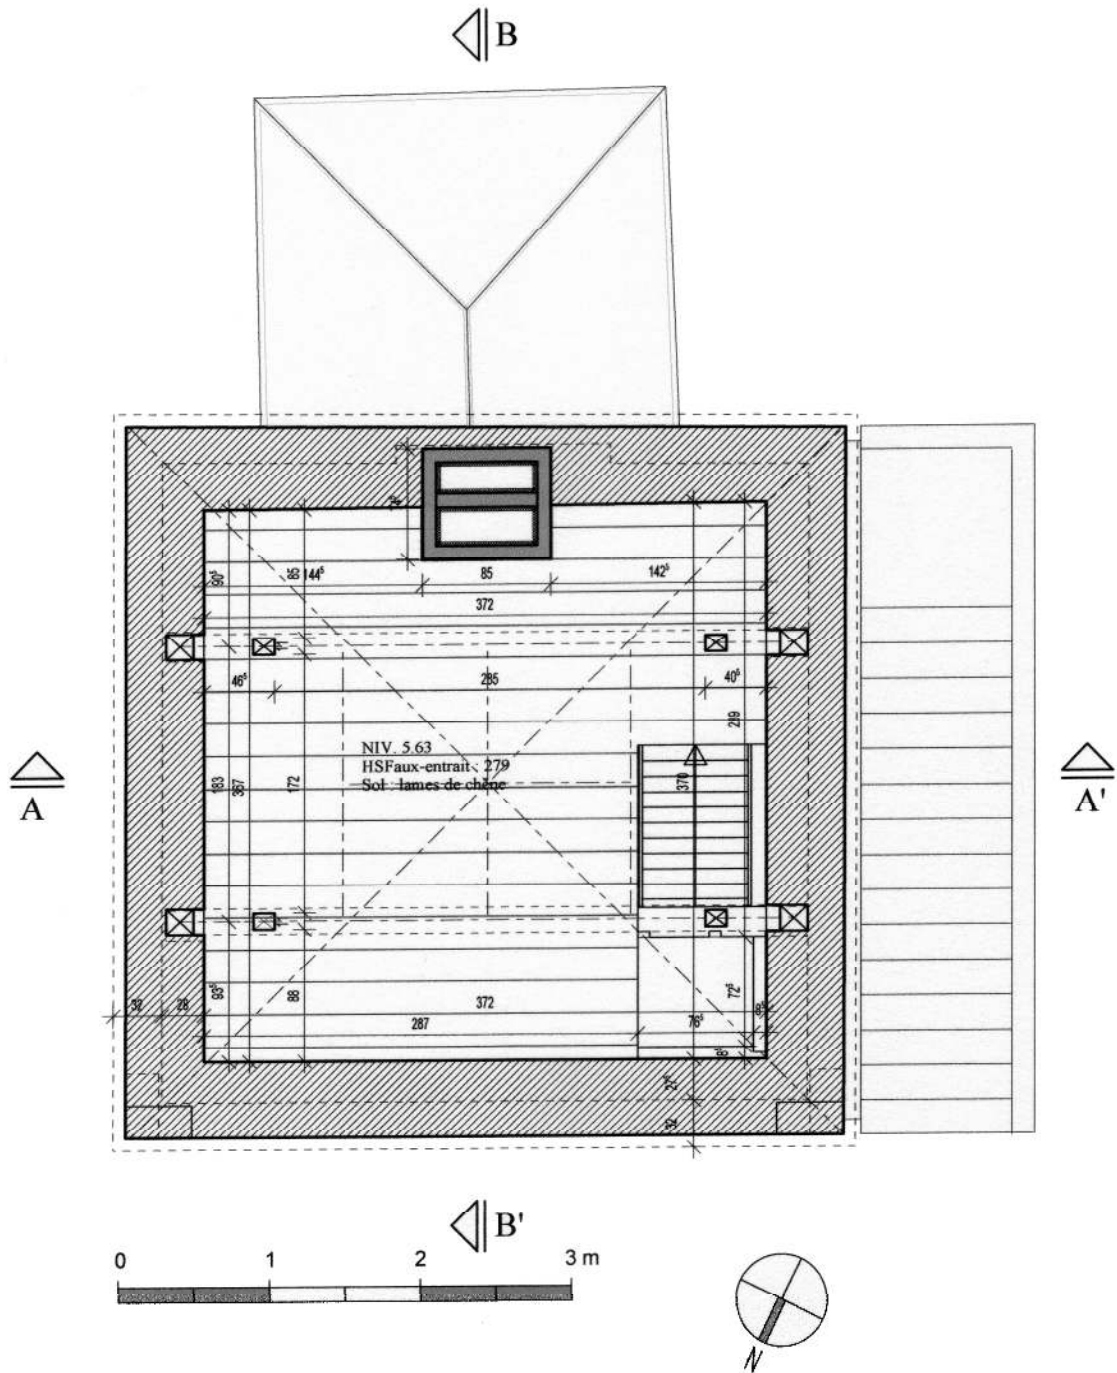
Pavillon. Vue en plan du comble. Ech. 1/50°. Etat projeté. IG 2008.
